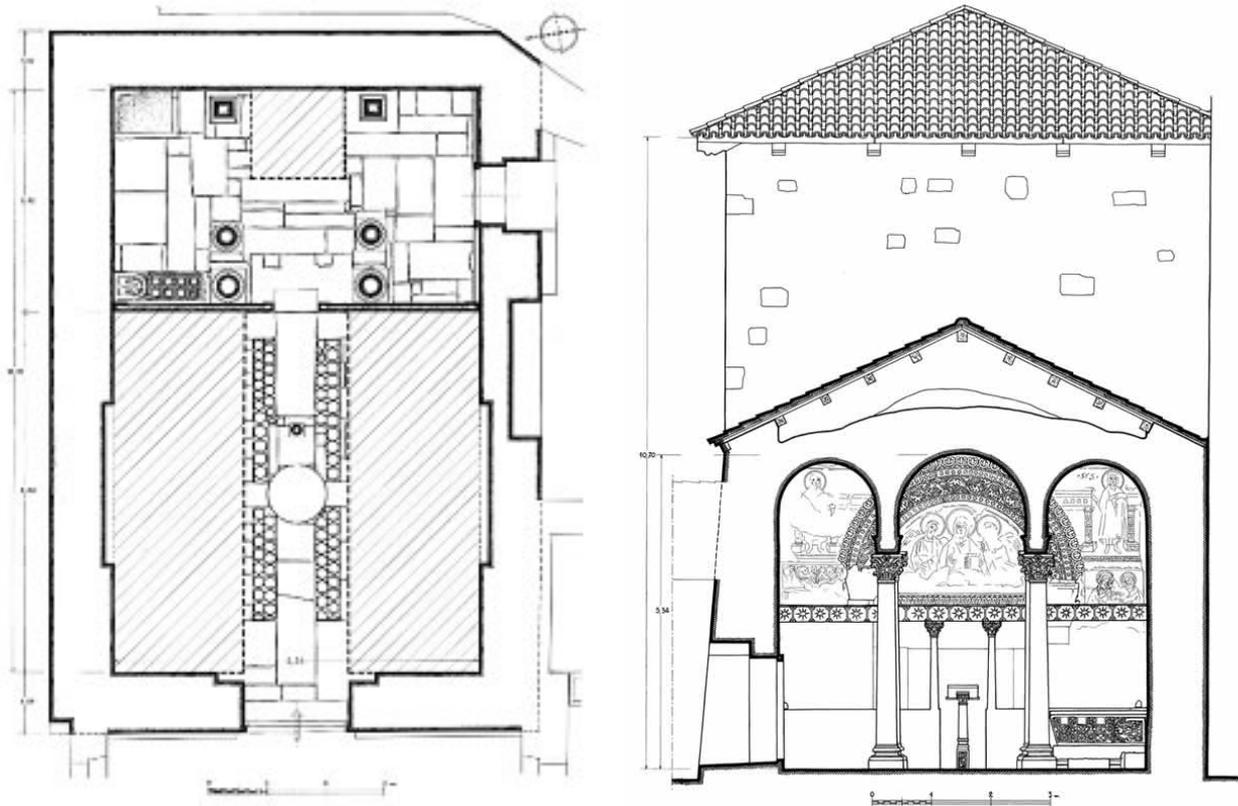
CIVIDALE: TEMPIETTO, A: PIANTA; B: SEZIONE (DA I LONGOBARDI 1990)
